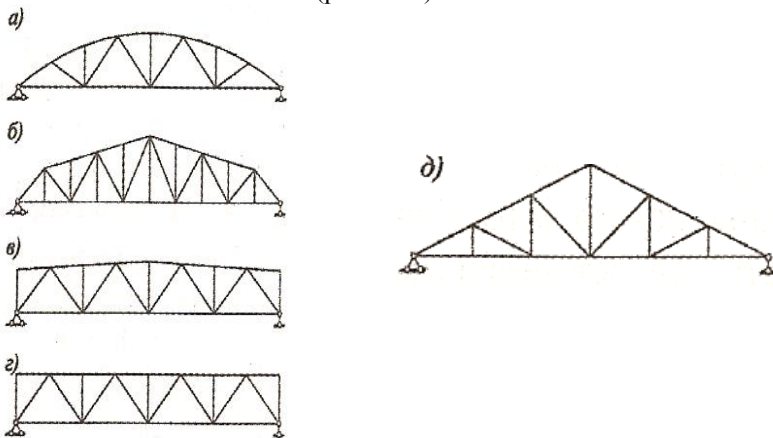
Очертания поясов ферм: а – сегментное; б – полигональное; в – трапецидальное; г – с параллельными поясами; д – треугольное
